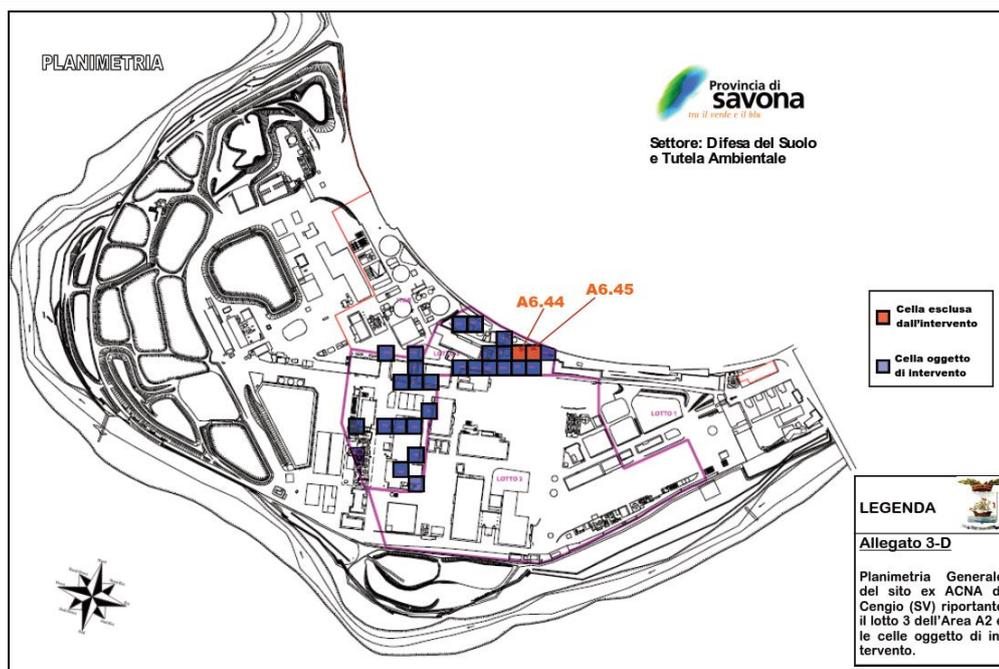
Planimetria Generale del sito ex ACNA di Cengio (SV)
